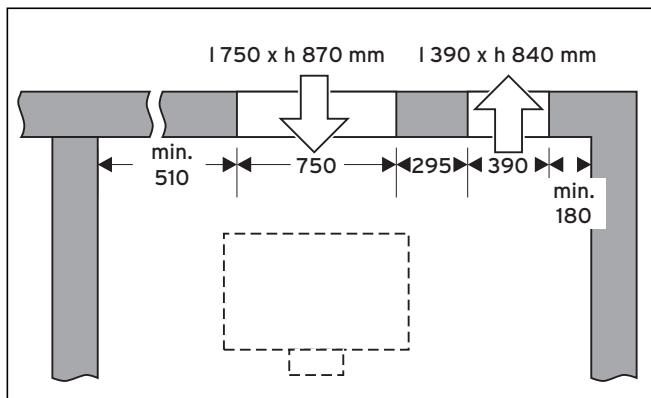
Installation sur un mur, sortie d'air à droite
